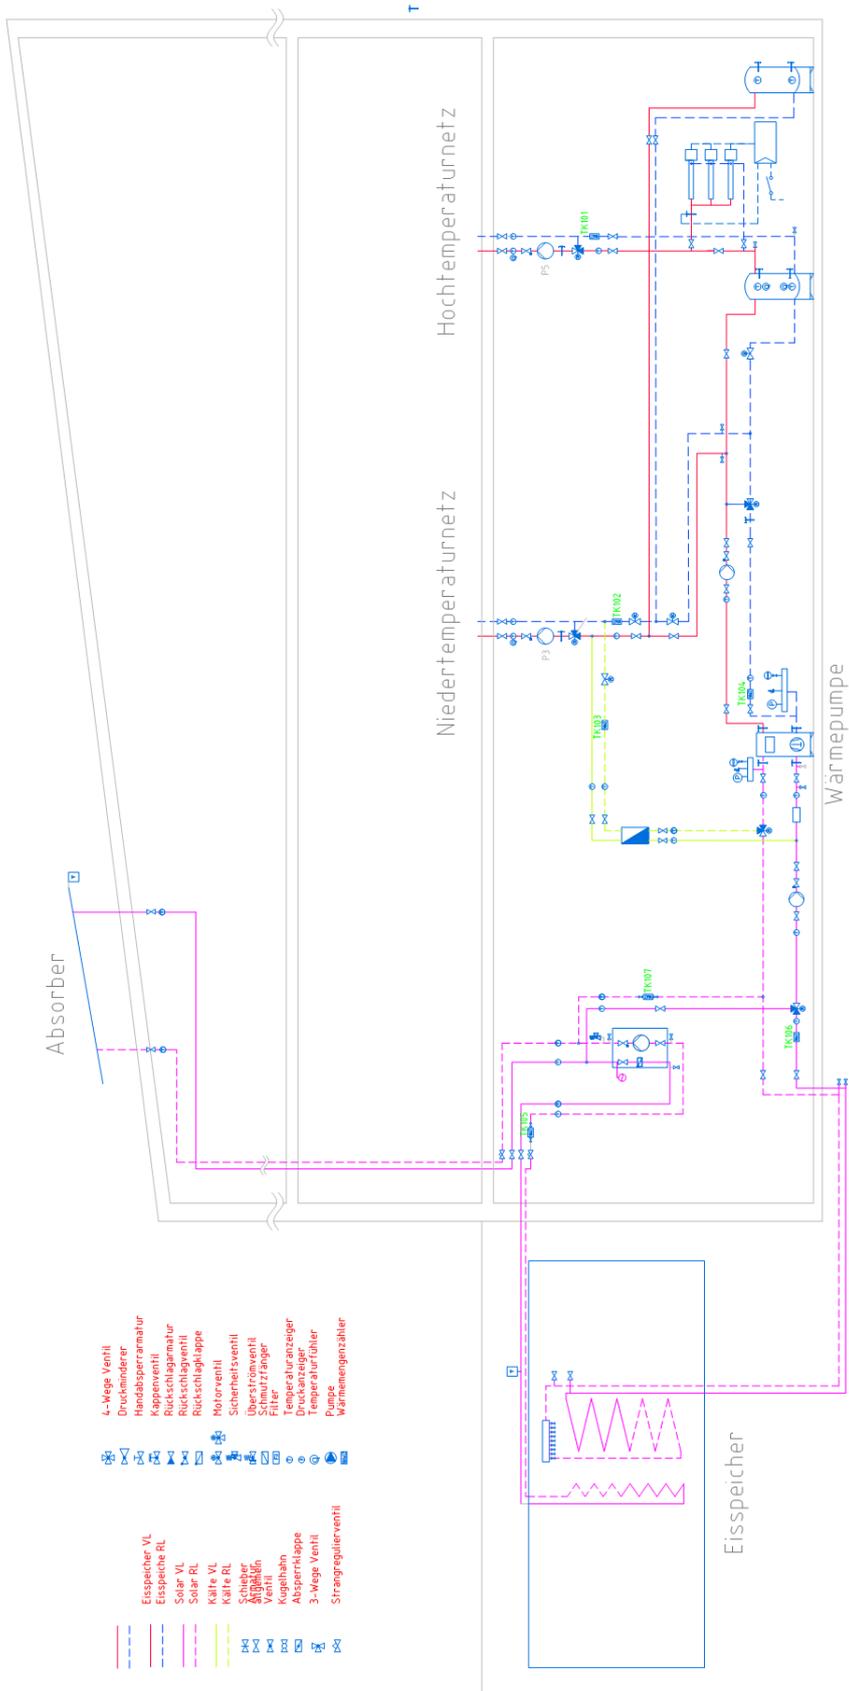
Hydraulikschema ab April 2016, Quelle: egs-plan, angepasst durch IGS
